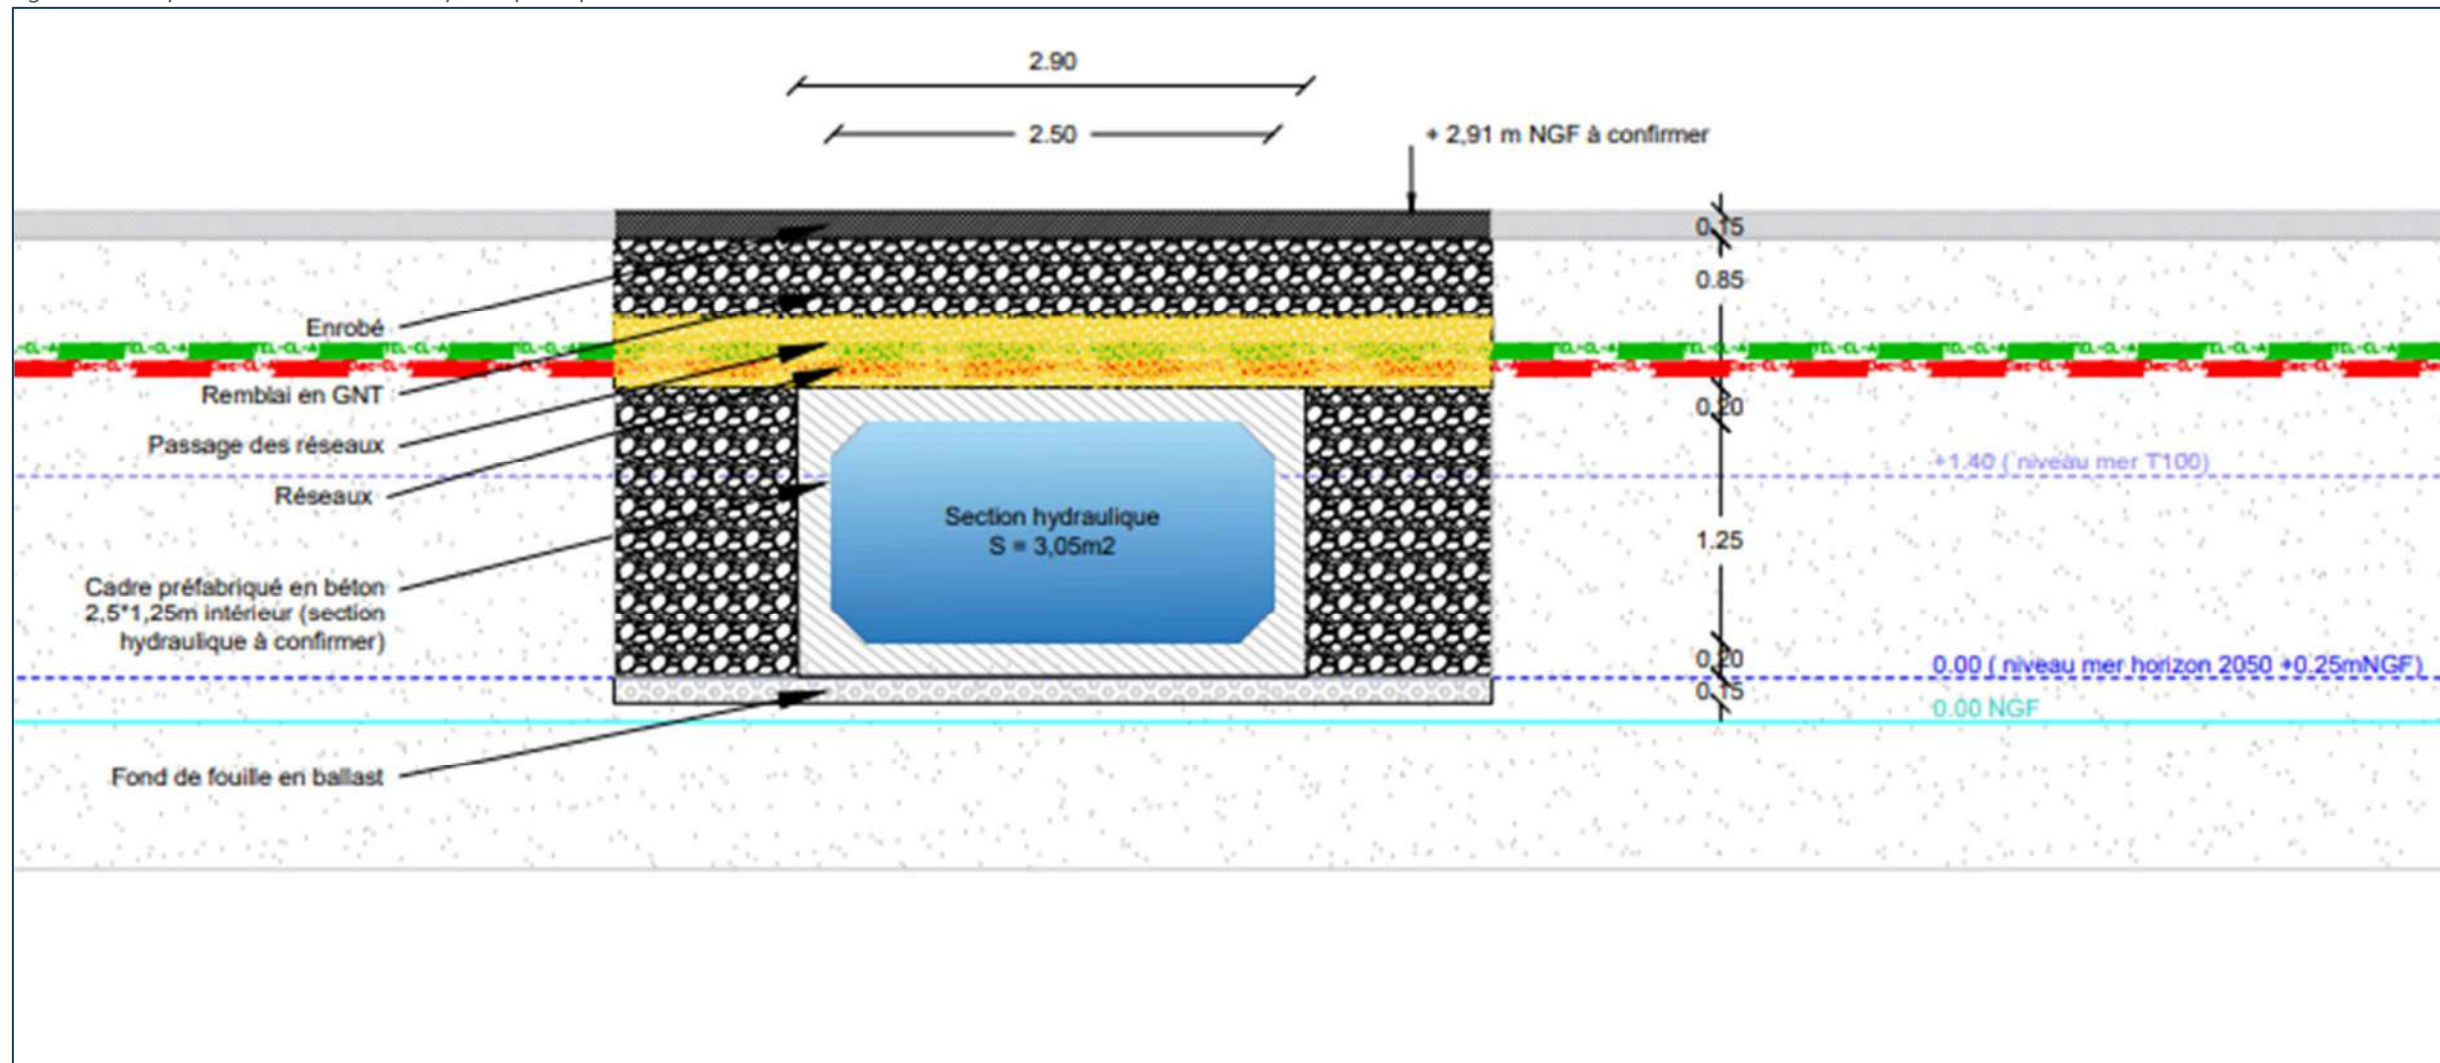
Coupe transversale CC : Coupe de principe de la chambre en béton entre le cadre béton et l'épi en mer
